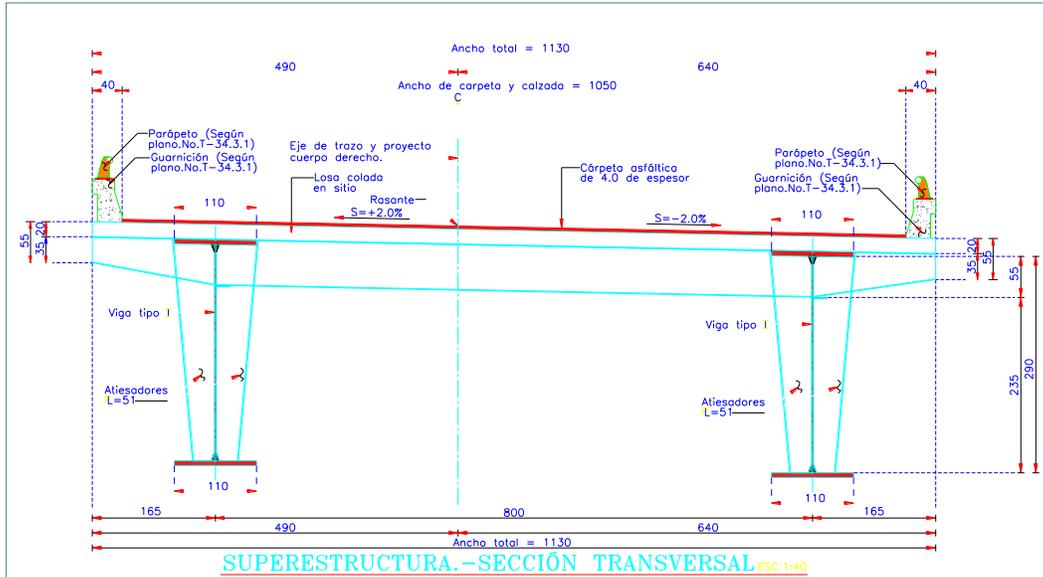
Sección transversal – Cuerpo derecho – Viaducto Las Canteras II
